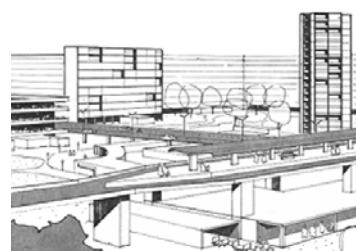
Fragmento de una perspectiva general de Bijlmermeer de 1968, en la que se puede ver en primer plano las vías de metro con los centros comerciales en planta baja, y en segundo plano el viario secundario y la edificación en altura. Fuente: Horst et al., 1991, p. 54.
